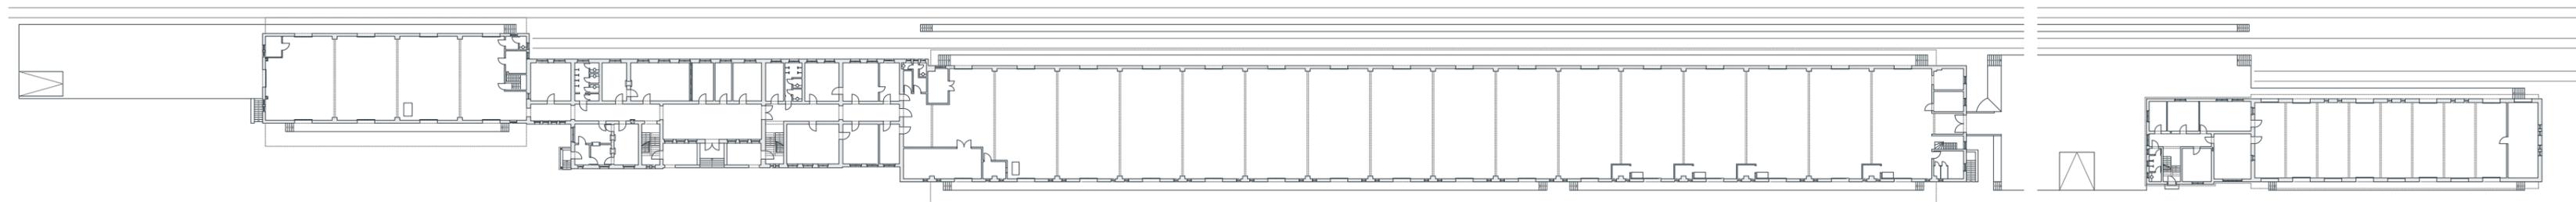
Grundriss des Erdgeschosses der Gesamtanlage, 1904 o.M.
